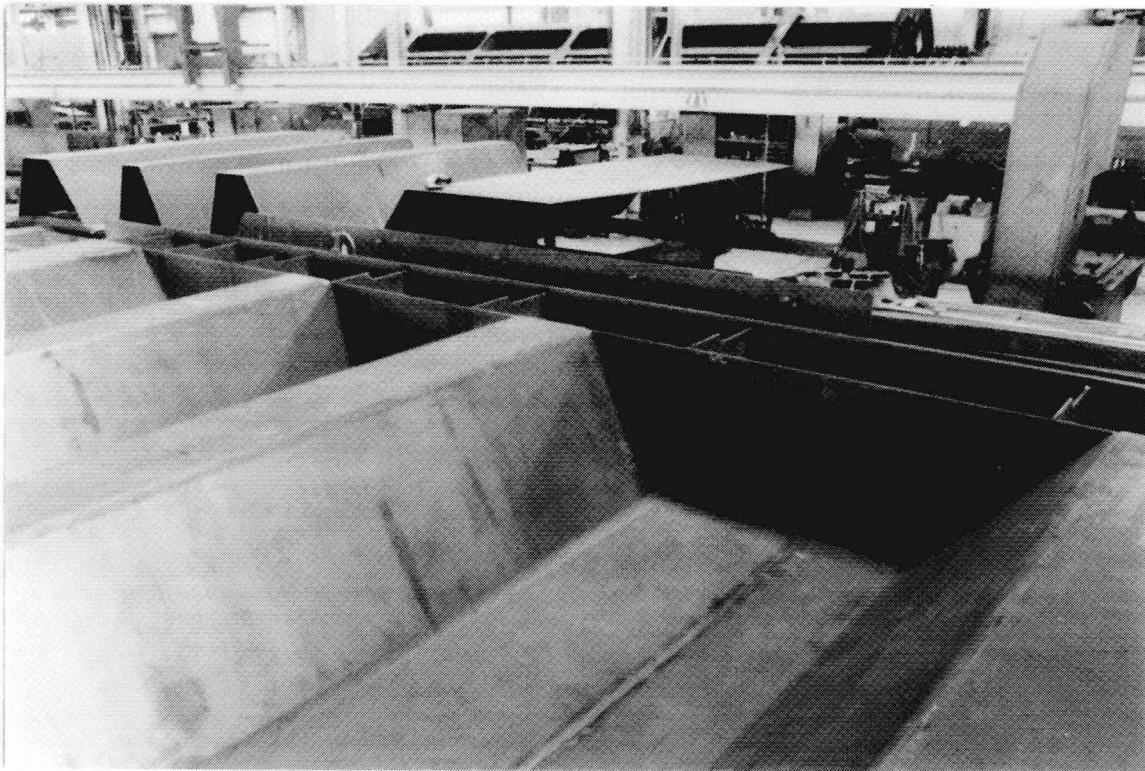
Faltwerktoore Schleuse Saarbrücken in der Fertigung (Werksfoto Stahlbau Lavis)
